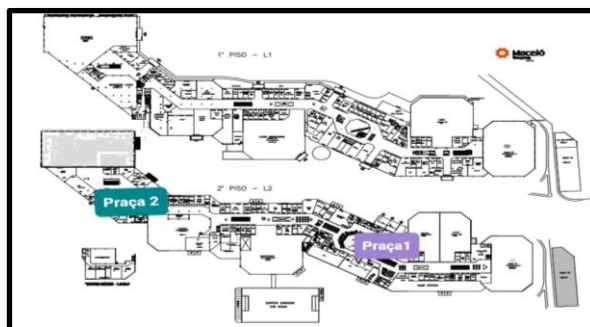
Planta baixa do Maceió Shopping, evidenciando as duas praças de alimentação no segundo piso do mesmo (SITE DO MACEIÓ SHOPPING).
